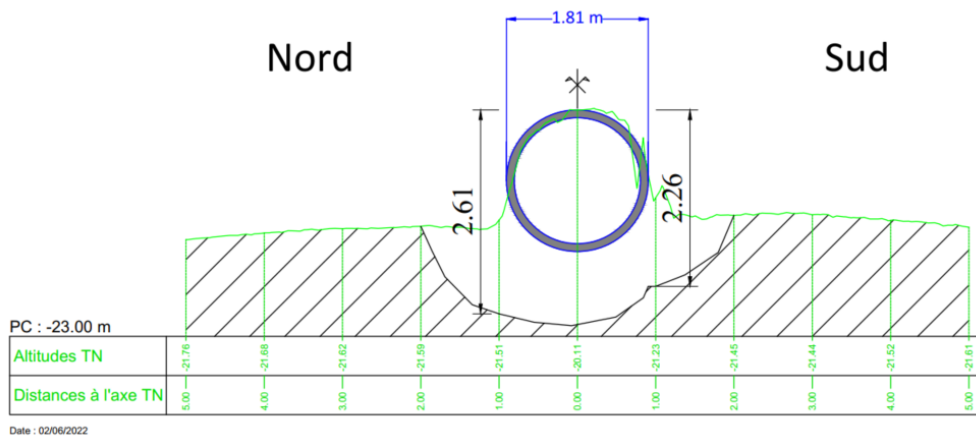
Coupe d'un affouillement au niveau de la coquille n°68 située entre les tubes 69 et 68 (MARE NOSTRUM, 2022).
